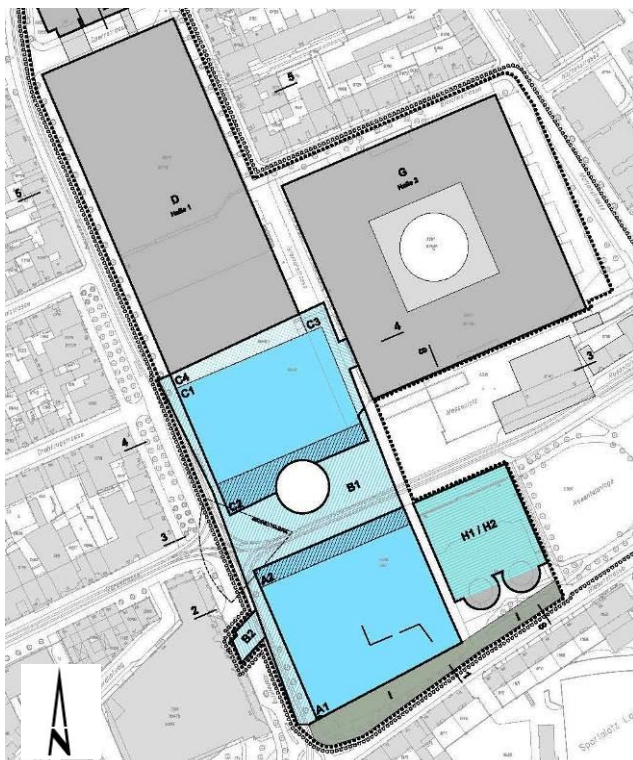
Bestehender Bebauungsplan Nr. 182 (PI-Nr. 13'241)
